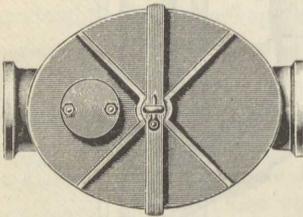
Fettfang mit beliebig drehbarem Einlauf.
